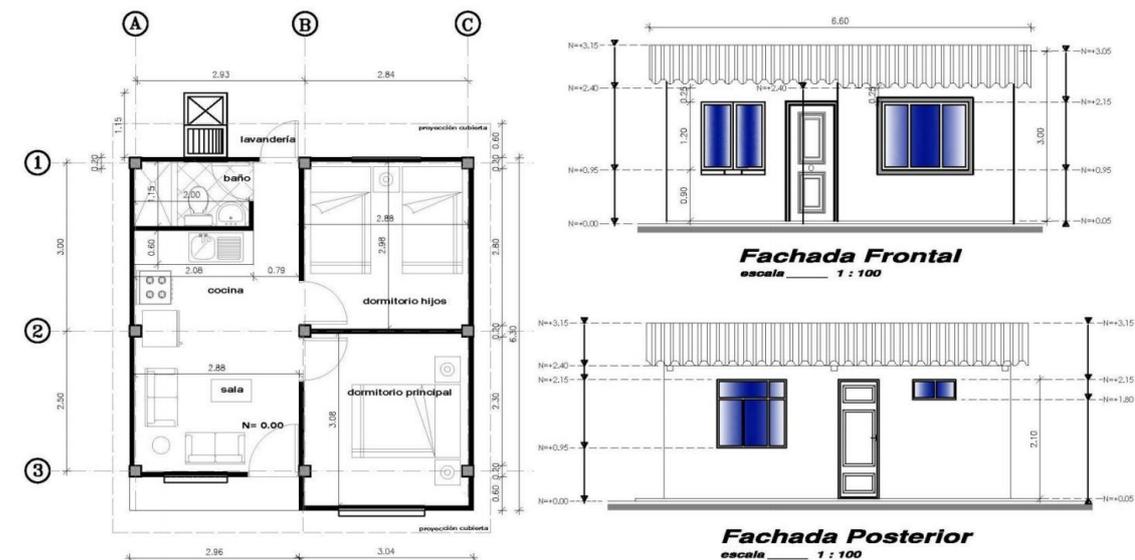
Plano de vivienda tipo (MIDUVI).
